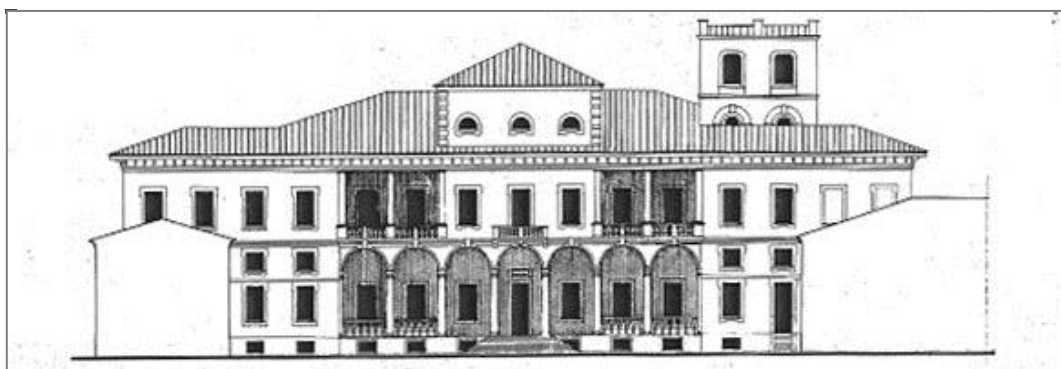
M.A. Dal Re, prospetto ovest di villa Ghirlanda Silva, 1726
